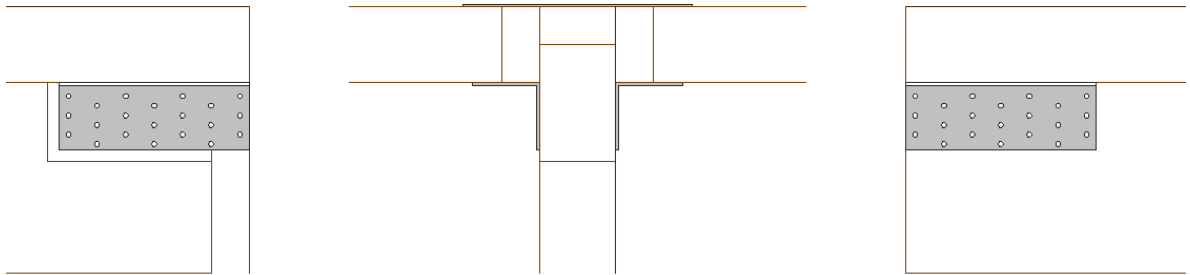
, Vista laterales y en planta de conexión tipo codo - TCF200 - (ROTHOBLAAS, 2016).
